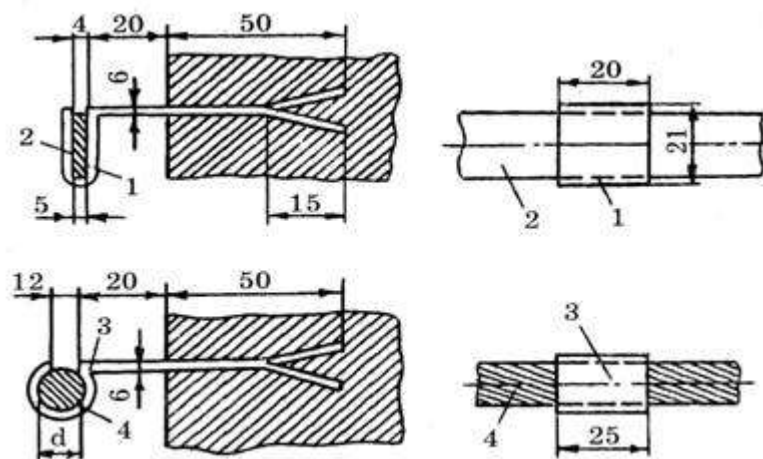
Схема кріплення заземлювальних провідників у камері з бетонним кріпленням:
